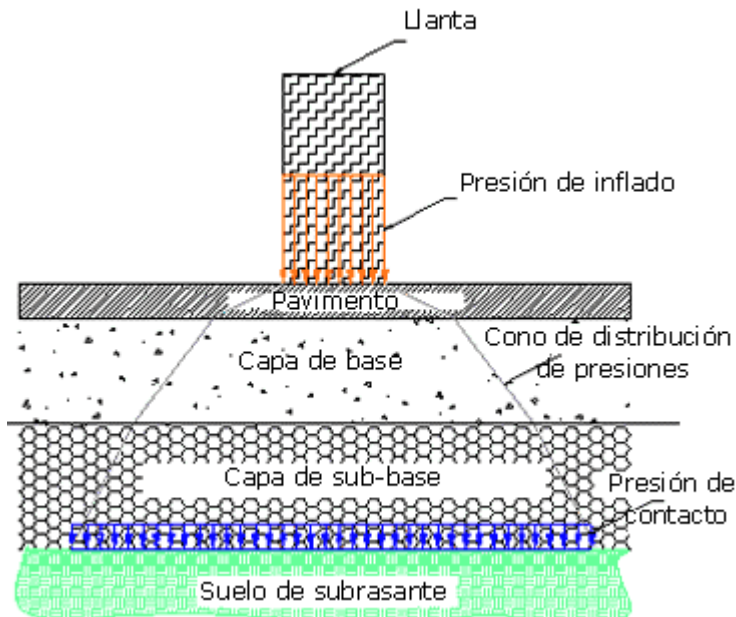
b.11 Distribución de presiones tronco-cónica en la estructura de un pavimento.
